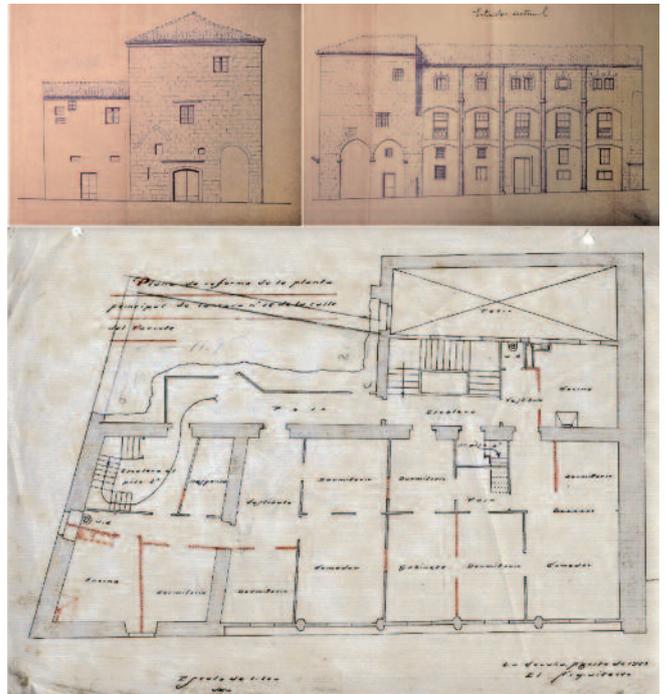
Eduardo Rodríguez-Losada Rebellón, Casa Gótica, alzados exteriores y planta, 1925 (Archivo personal de Jacobo Rodríguez-Losada Allende).
